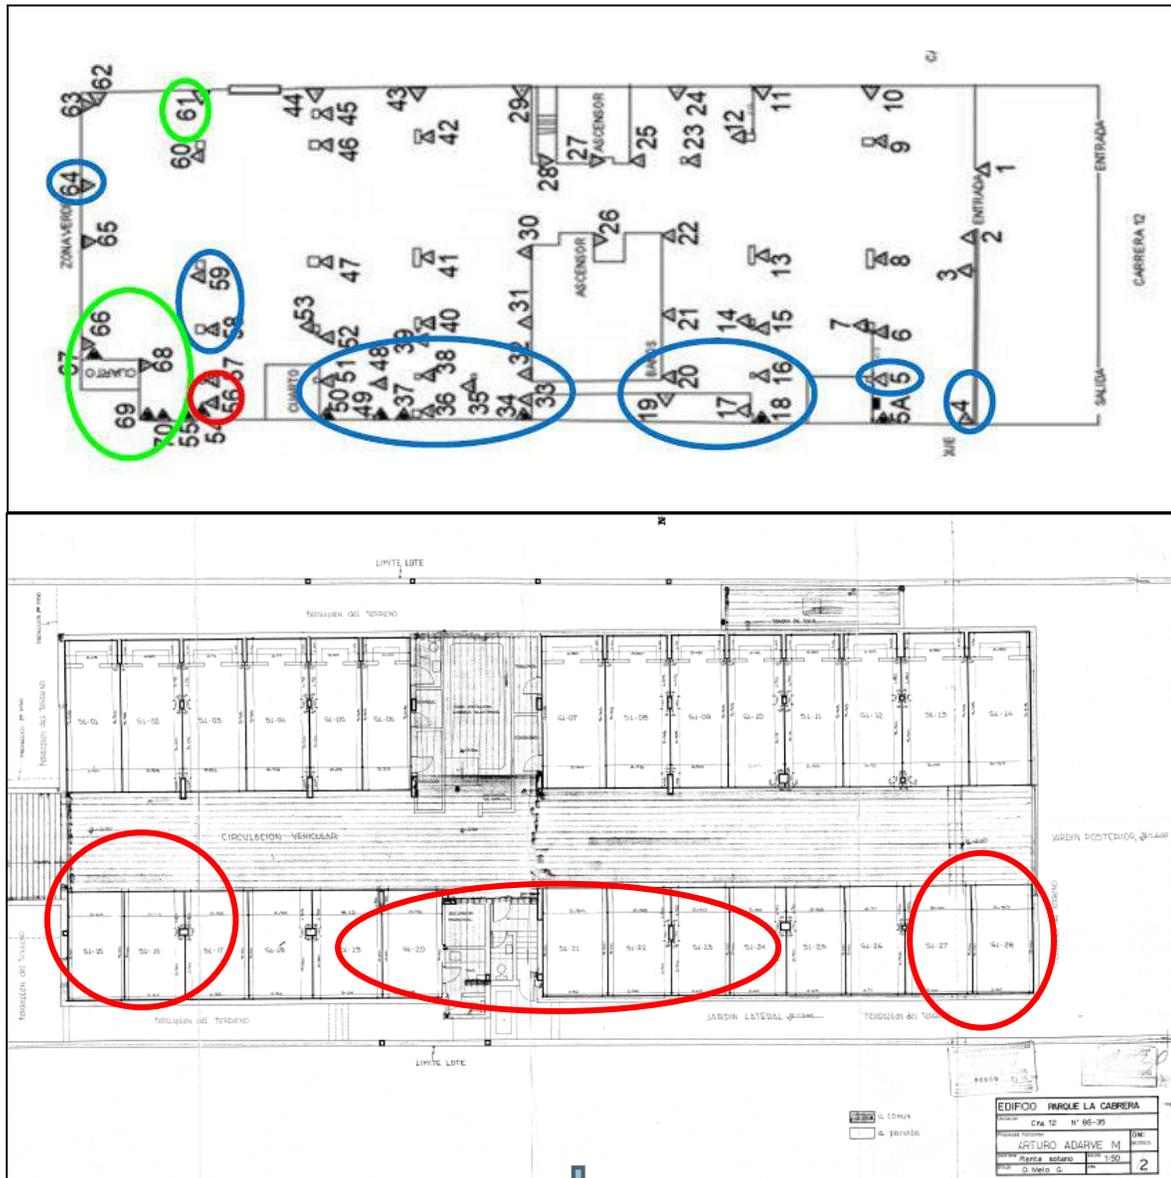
Planta sótano. Ubicación asentamientos Ed. La Cabrera
